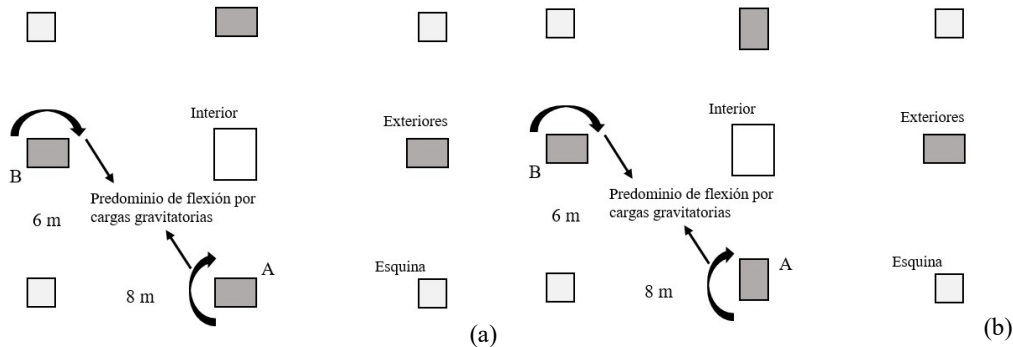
Representación en planta (no escala) de una posible solución de una planta del caso de estudio de la Fig. 3, (a) las cuatro columnas exteriores tienen la misma sección y (b) las cuatro columnas exteriores tienen la misma sección, pero la sección "A" fue girada 90° (la variable adicional es igual a 1)
